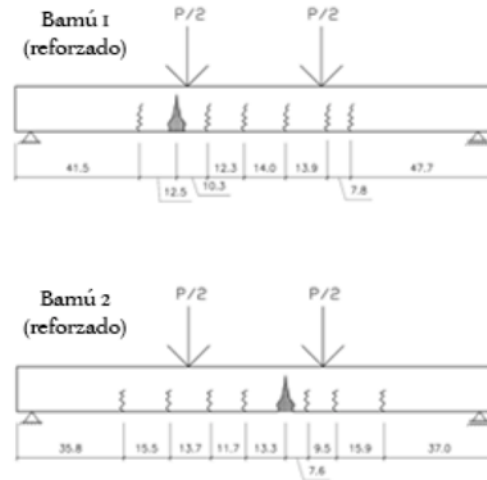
Agrietamiento de las vigas 1 y 2 reforzadas con bambú, medido en centímetros.
